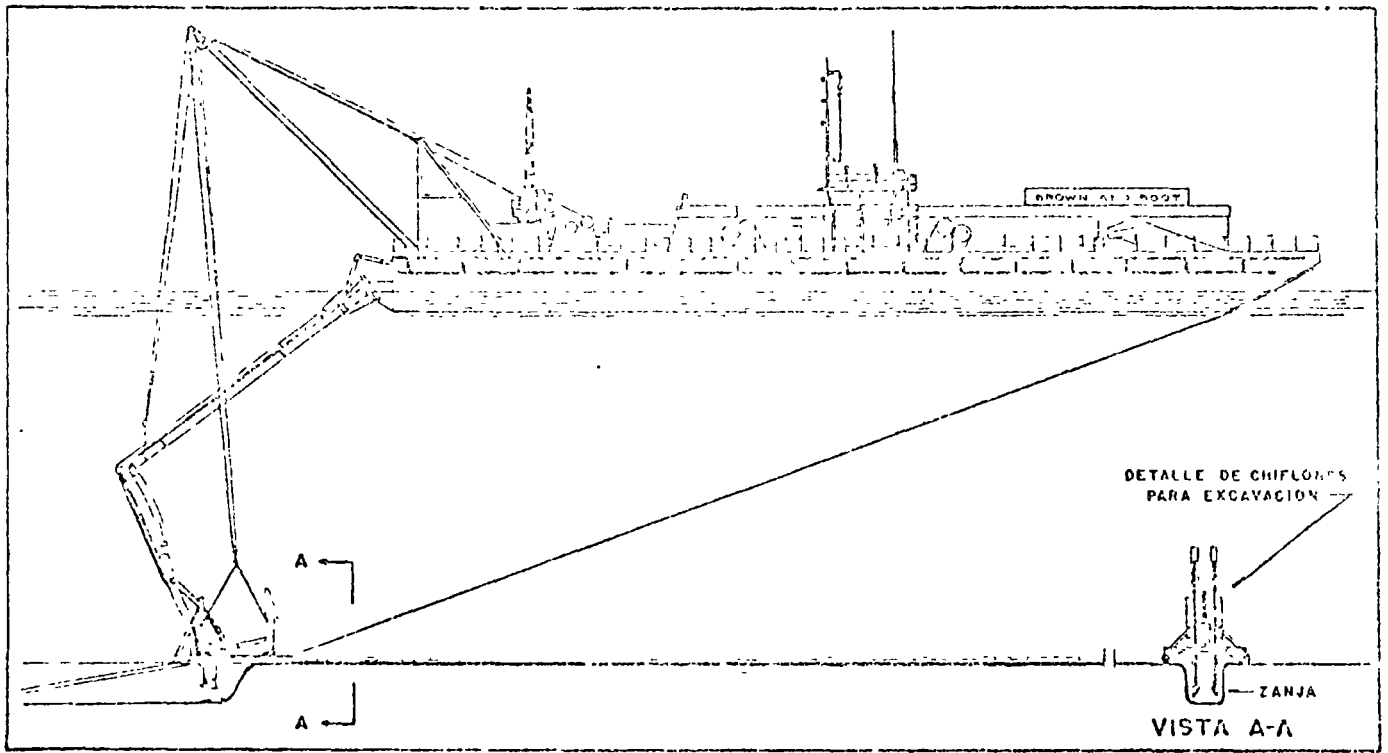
A.- DETALLE TIPICO DE BARCAZA CON EQUIPO PARA EXCAVACION EN EL FONDO DEL MAR
